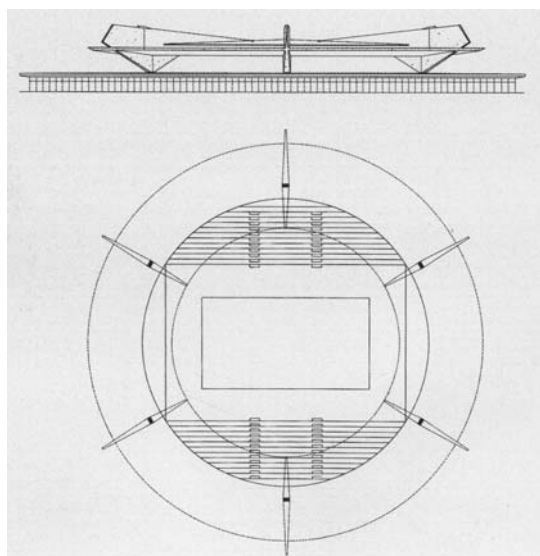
(esq.): elevação e planta nível superior. Fig. 346: planta nível subsolo.
